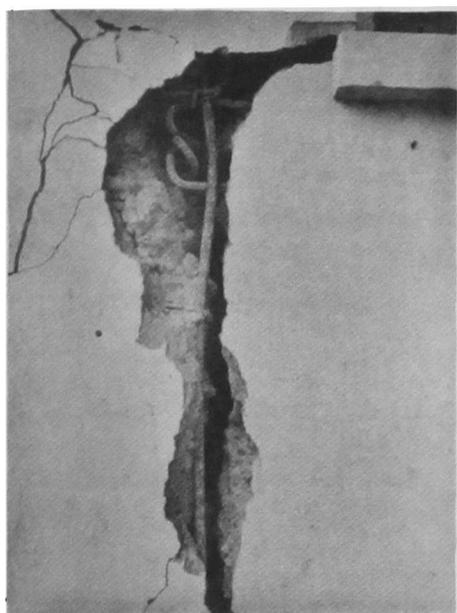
La armadura de la cadena apenas alcanzaba al pilar. Casa en calle Beaucheff. Valdivia.
